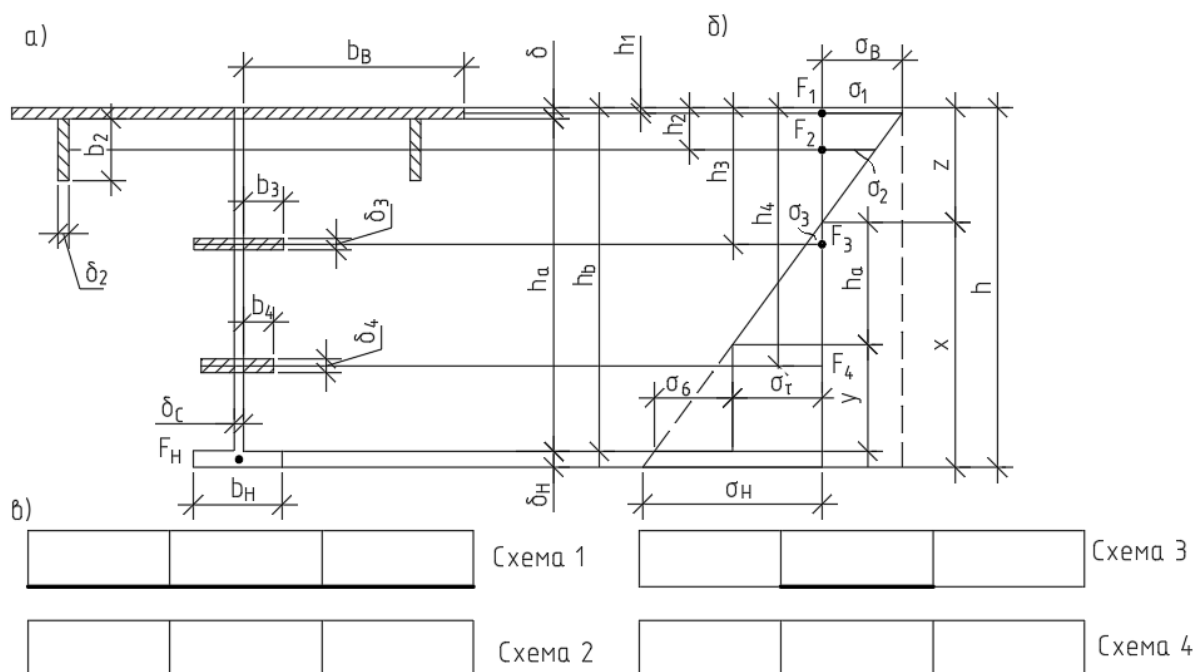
Расчётная схема, эпюра предельных напряжений и схемы пролётных строений:
